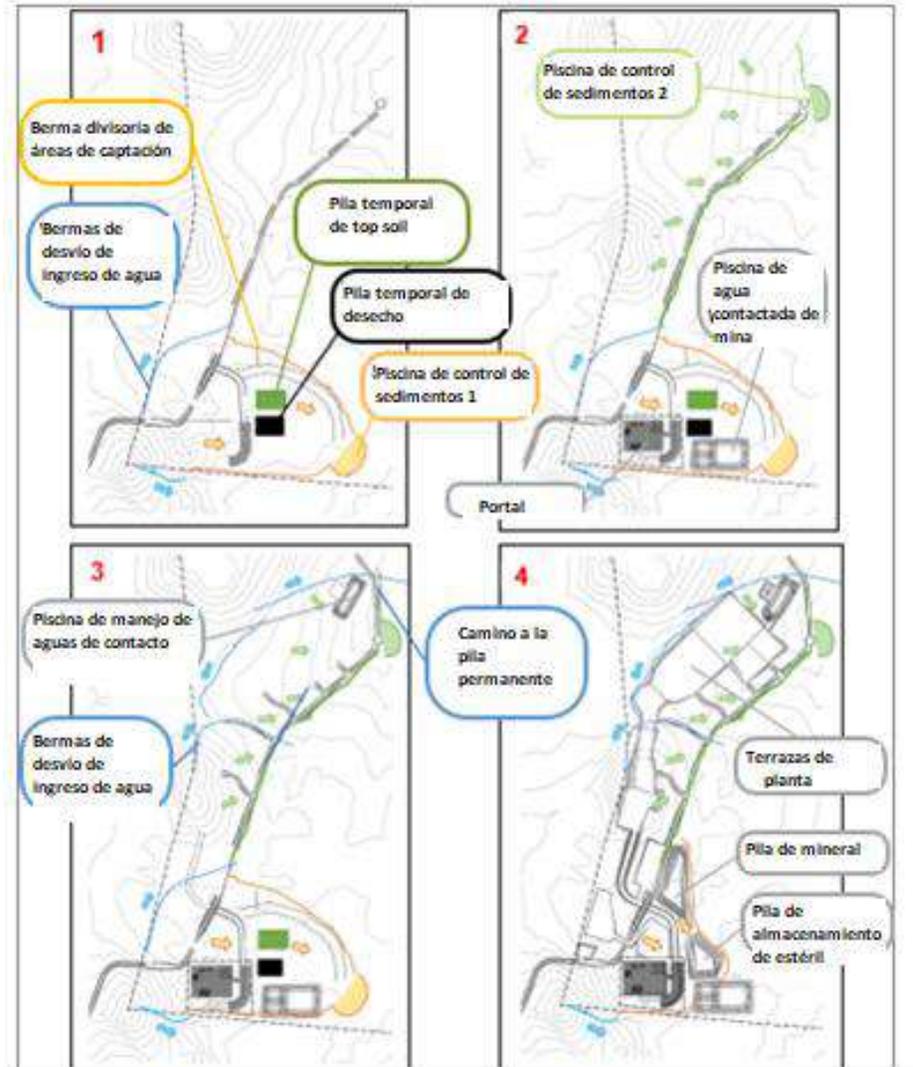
Secuencia de Construcción de la Mina y de la Planta de Procesamiento de Mineral
